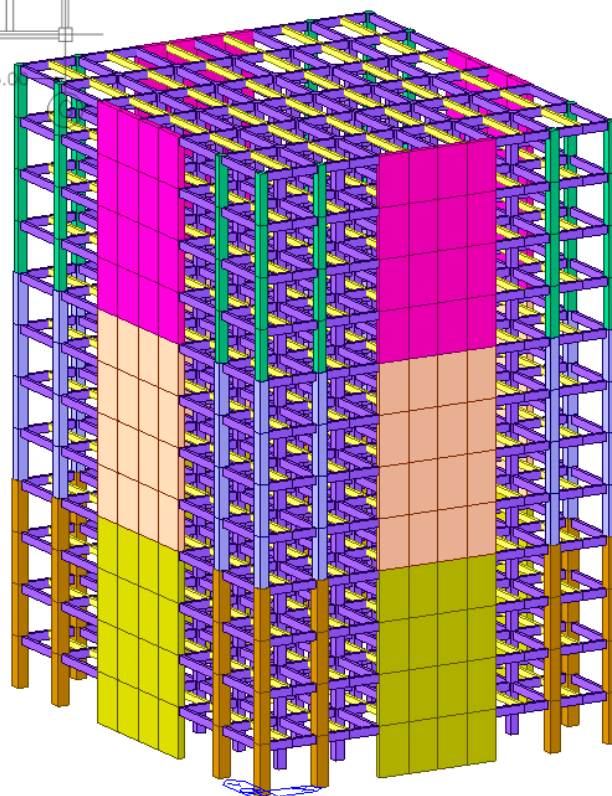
14 Planta y elevación de edificio de doce niveles para el diseño de DDBD
